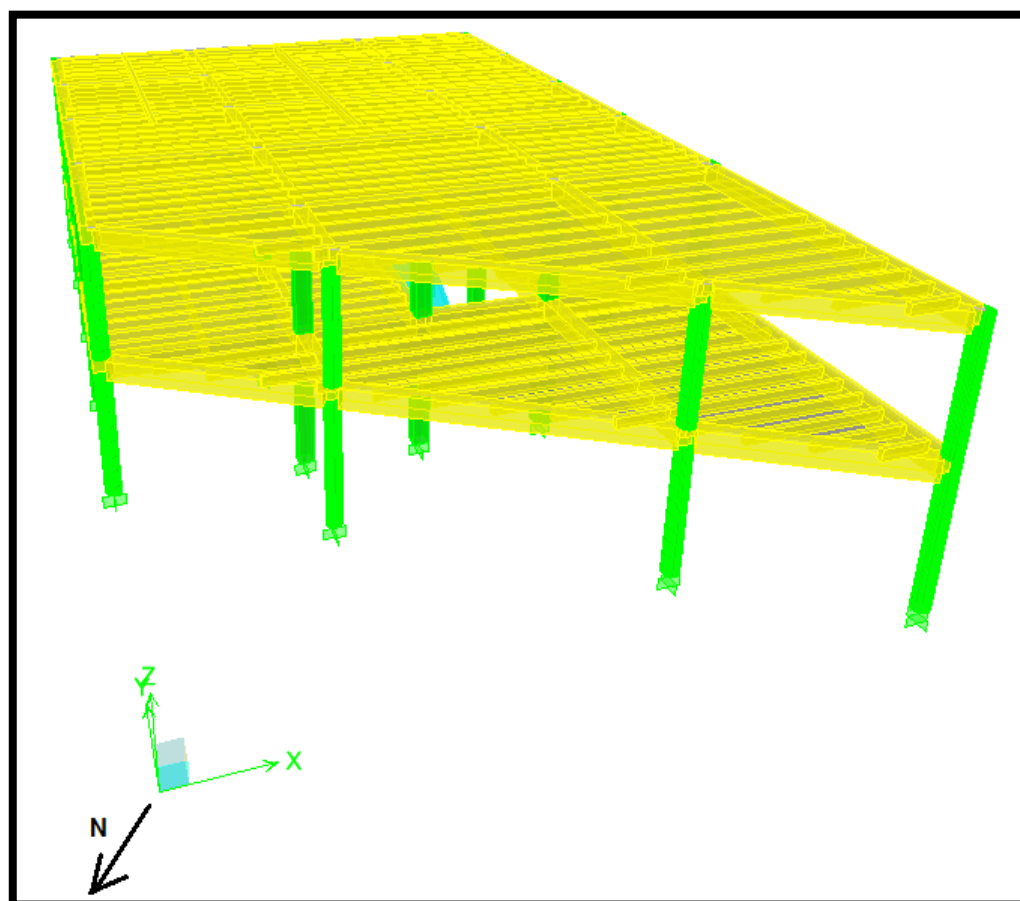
Vista 3D Edificio Módulo 4 (Fachada Norte)
